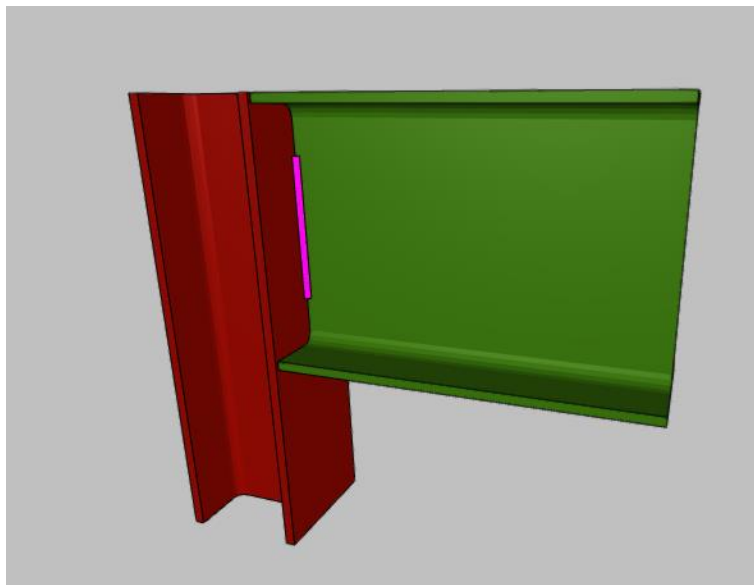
Ejemplo de unión pilar – viga articulada ejecutada con soldadura [7].
